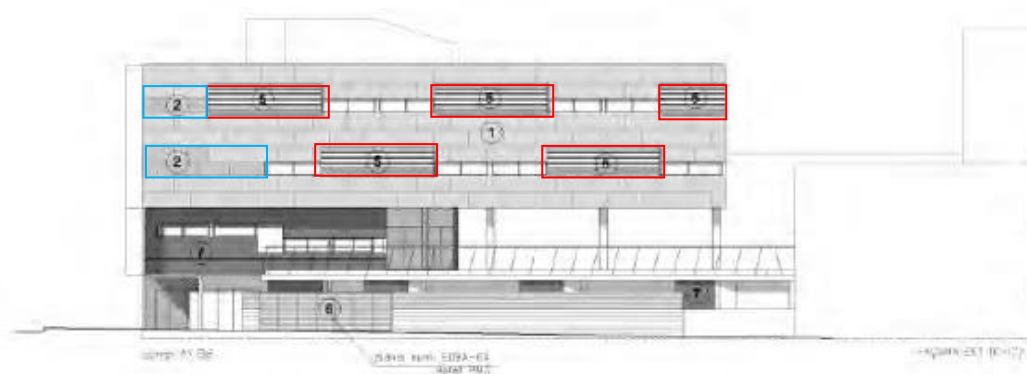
Vista exterior de la fachada: parte opaca (predominante), lamas (rojo) y las placas perforadas (azul). Fuente: SANTOS SÁ, 2012 adaptado por la autora.
